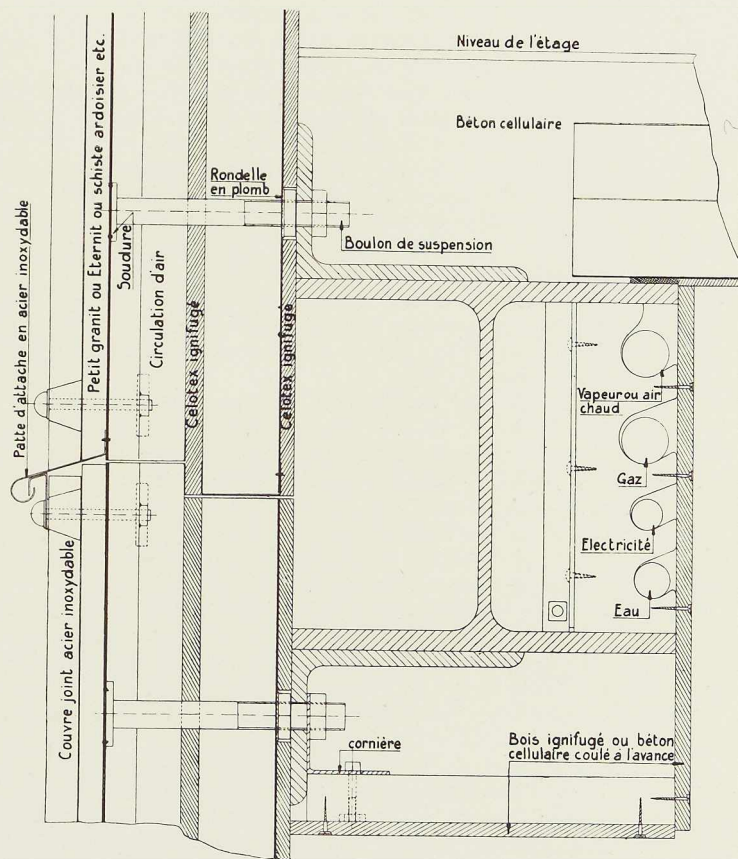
Rencontre d'un mur de façade, d'un plancher et d'une poutre de rive.
